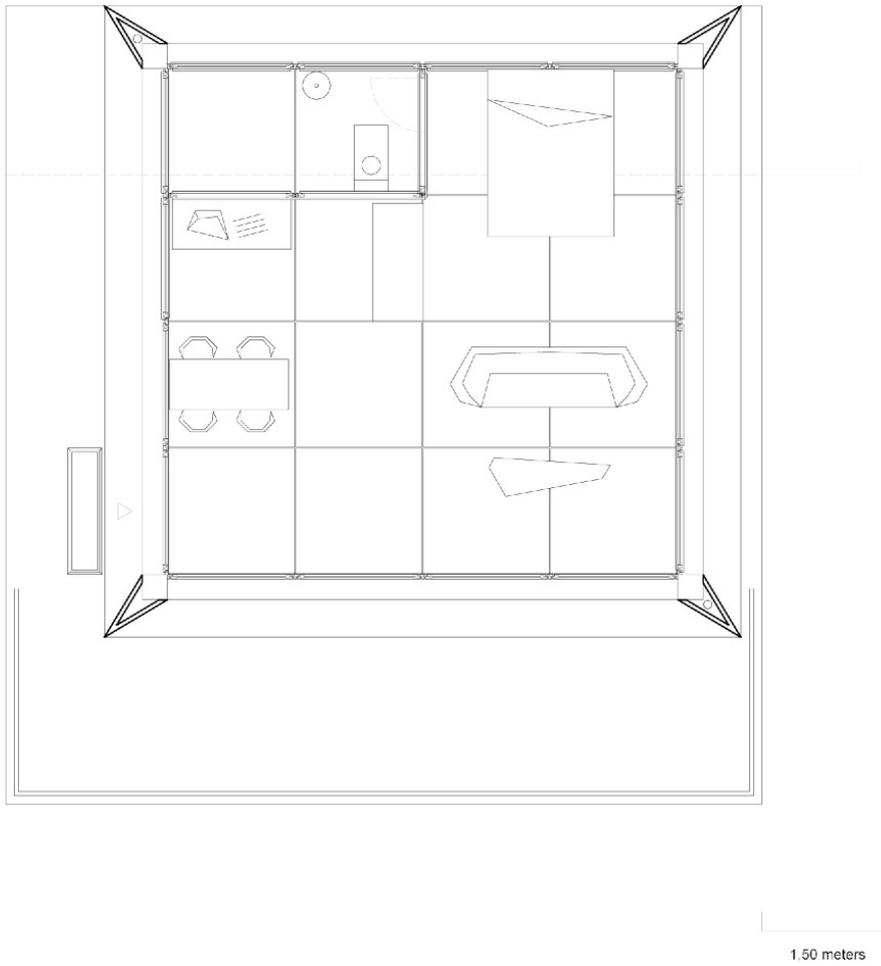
| Planta da habitação pré-fabricada *Mima House* com 36 m², fabricada num único módulo volumétrico. Nesta planta é visível a grelha de 1,5 metros que permite a recolocação das paredes, alterando assim o interior. Mima Architects, 2011.
